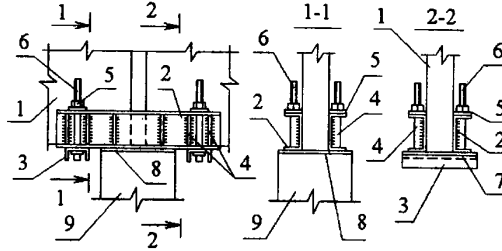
Підсилення вузлів обпирання залізобетонних балок:
